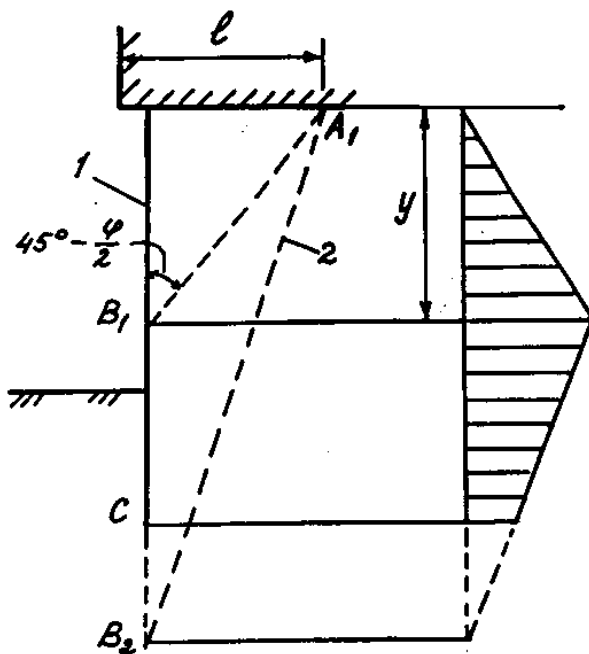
Схема к определению бокового давления грунта на переднюю шпунтовую стенку при наклоне экранирующем свайном ряде: 1 – шпунтовая стенка; 2 – экранирующая плоскость
